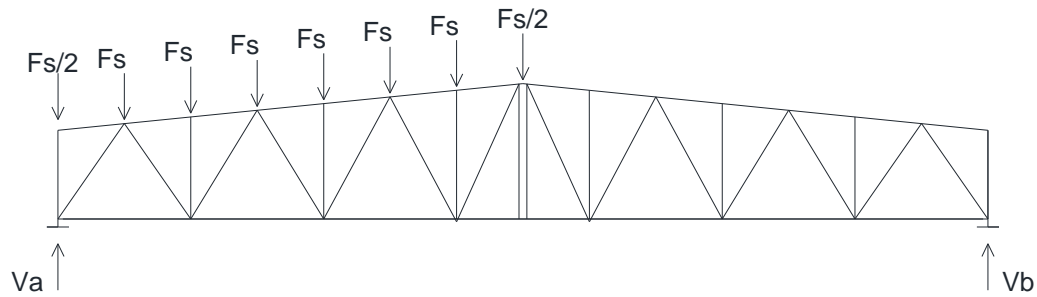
Схема приложения снеговой нагрузки на ферму (Вариант II)
